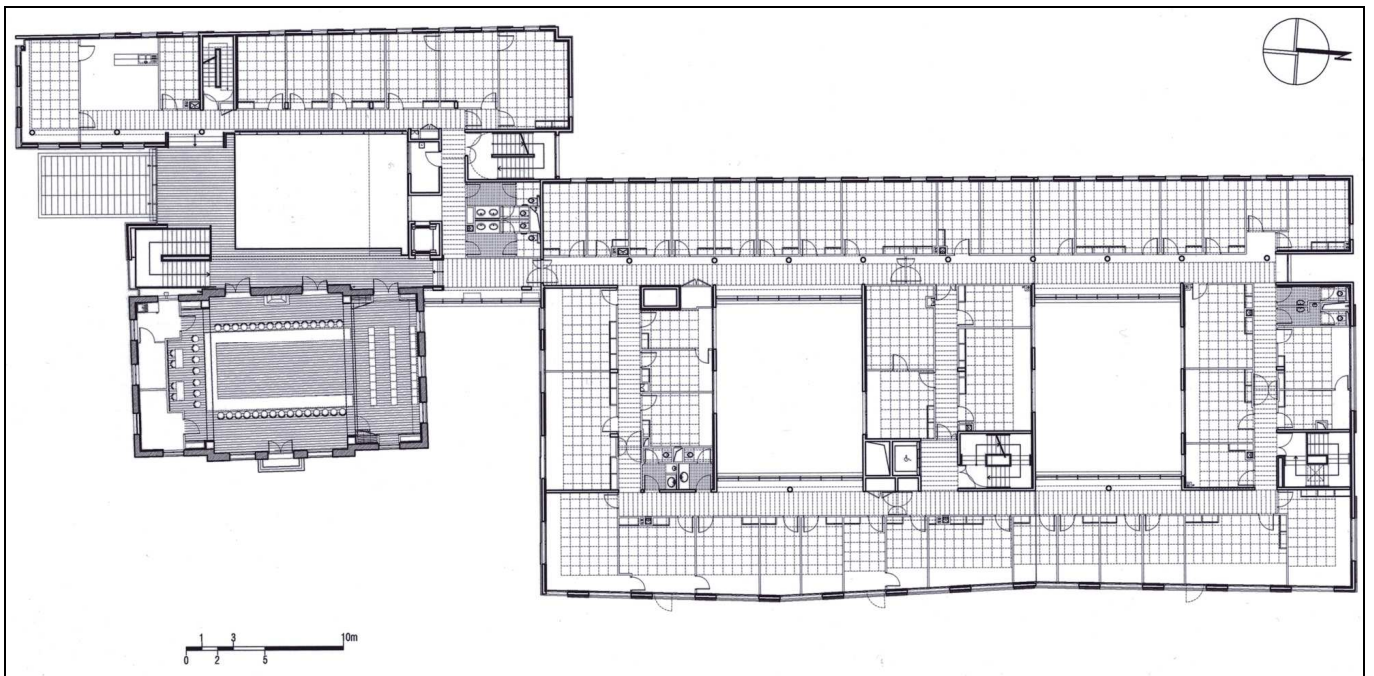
Mairie des Mureaux, plan rez-de-chaussée.
